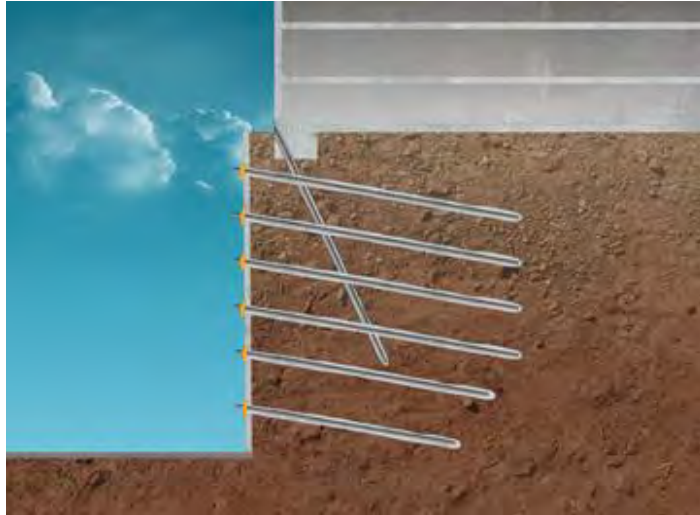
Soil nailing (Soil Nailing | Tecnologías | Pilotes Terratest S.A., s/f)
